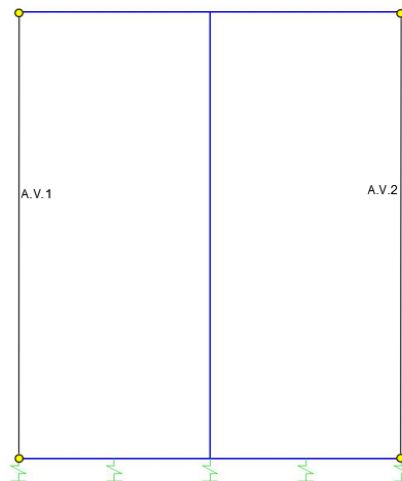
Corte en viga transversal de la zapata, con viga de carga perpendicular al eje del espécimen
